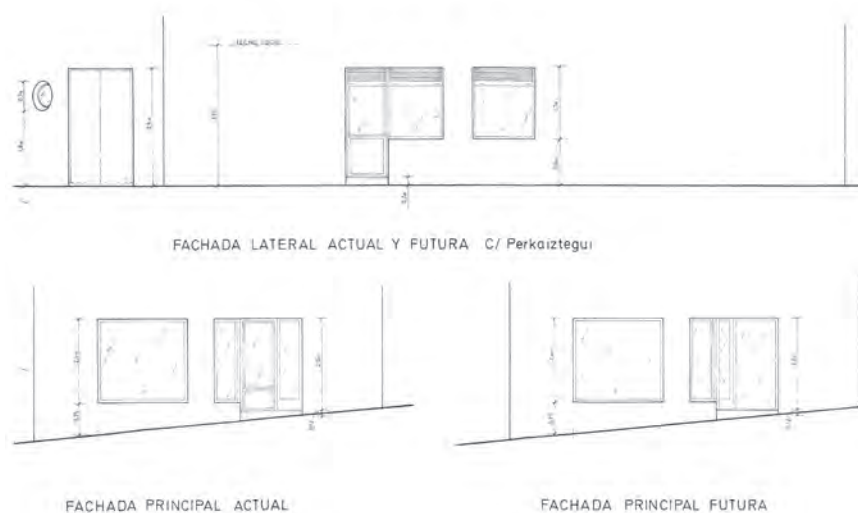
35. 1988. MODIFICACIÓN DE CARPINTERÍA EN HUECOS DE FACHADAS DE LA PLANTA BAJA
